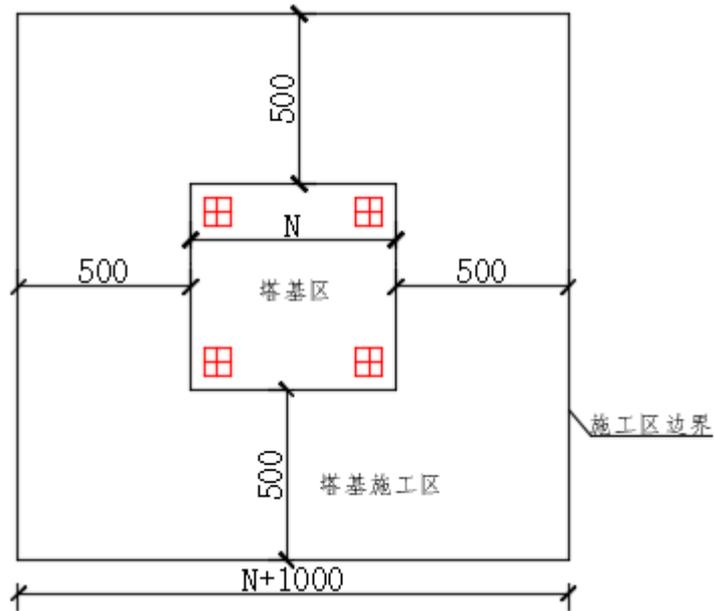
送出线路塔基及施工区平面示意图（单位：cm）
